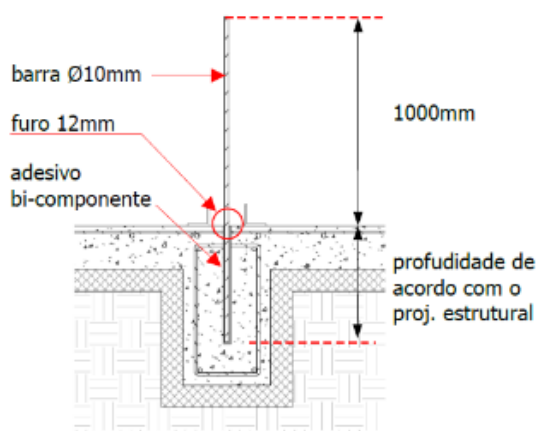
Detalhe da ancoragem entre parede e fundação. (Sem escala).
